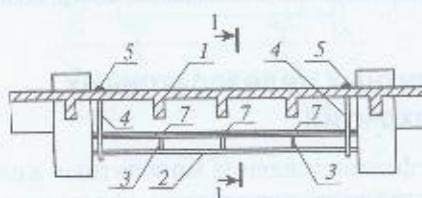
Усиление балок монолитного железобетонного перекрытия подведением разгружающих балок на хомутах:
